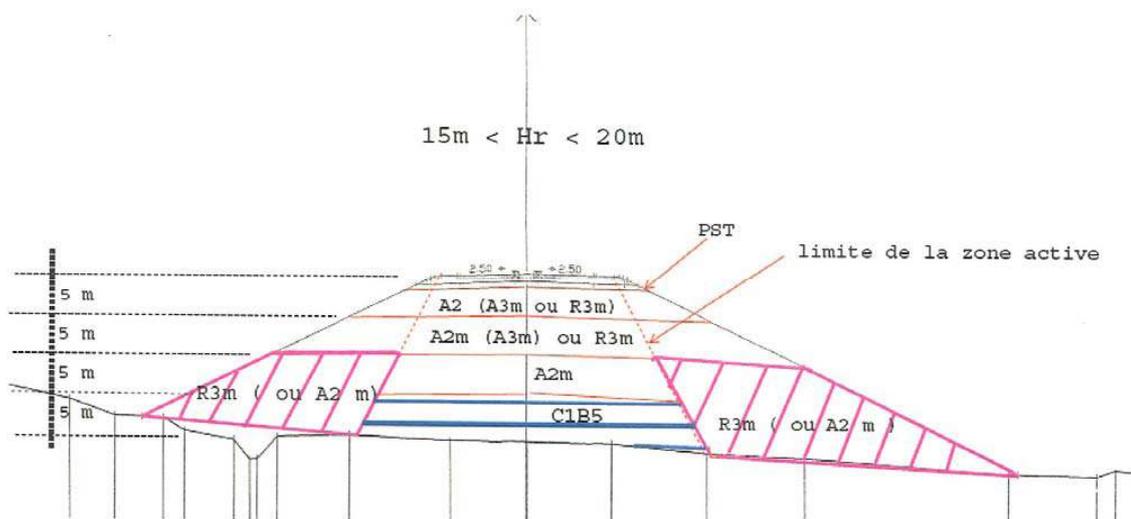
Schéma de montage d'un remblai de hauteur comprise entre 15 m et 20 m [1].
